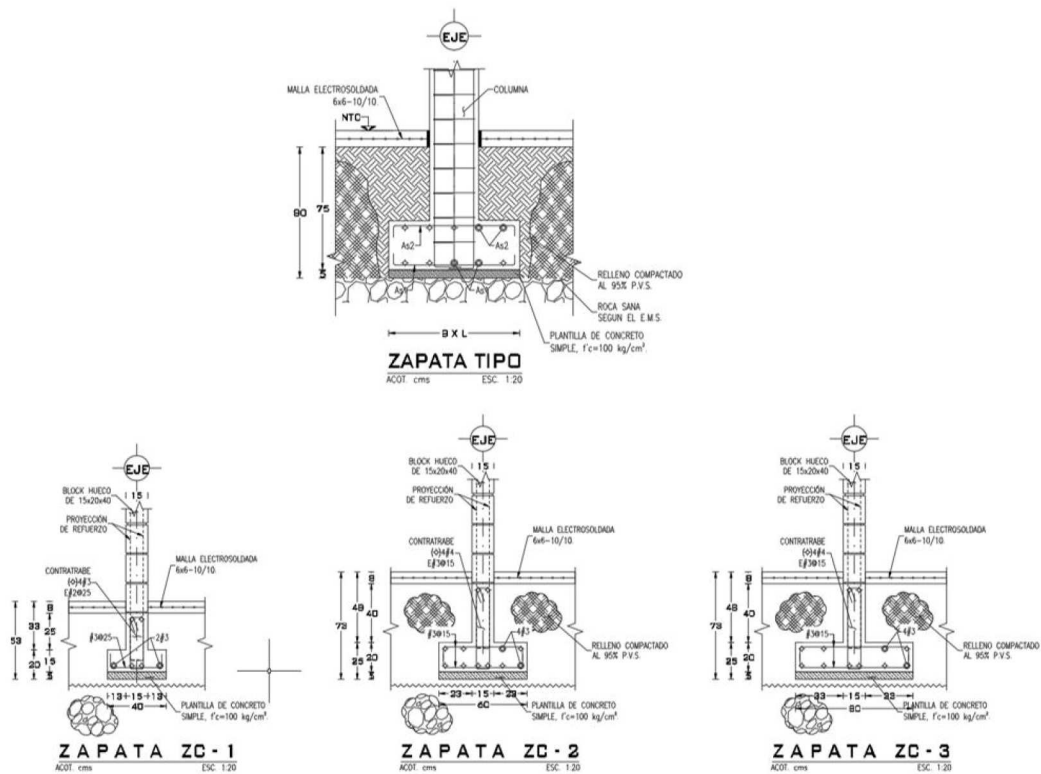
Detalles de la cimentación, el tipo de sistema constructivo tipo ZAPATA AISALADA.
